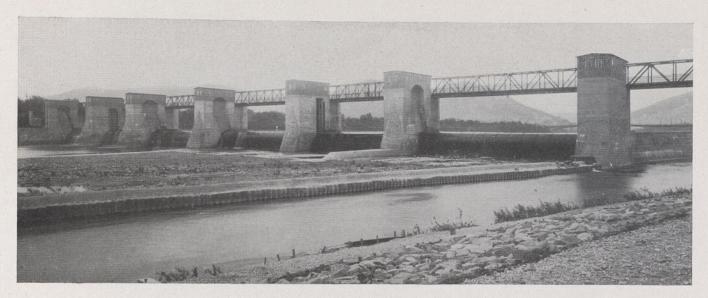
Staustufe Wieblingen, Wehr mit Unterkanal des Wehrkraftwerks.
